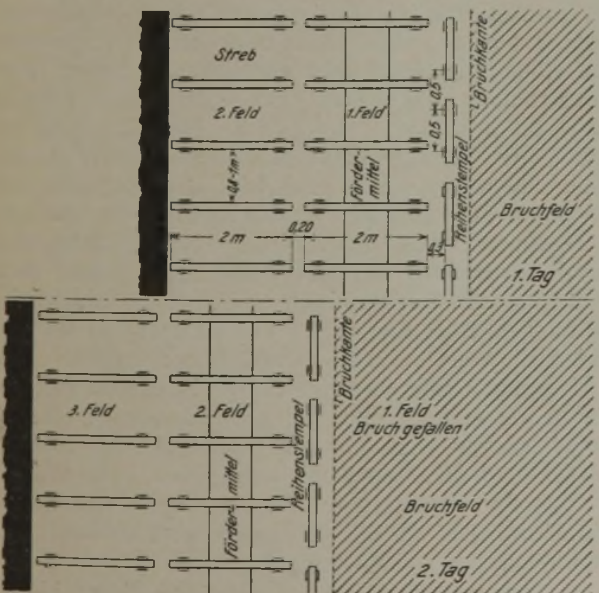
Bruchbau mit Reihenstempeln ohne Wanderkasten.
